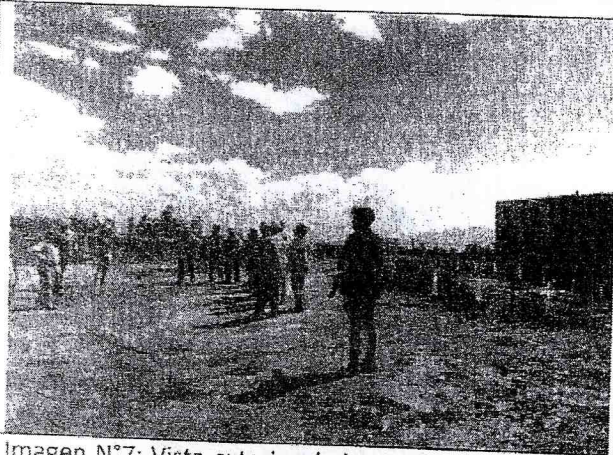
Vista exterior de la construcción - desalojo de trabajadores
